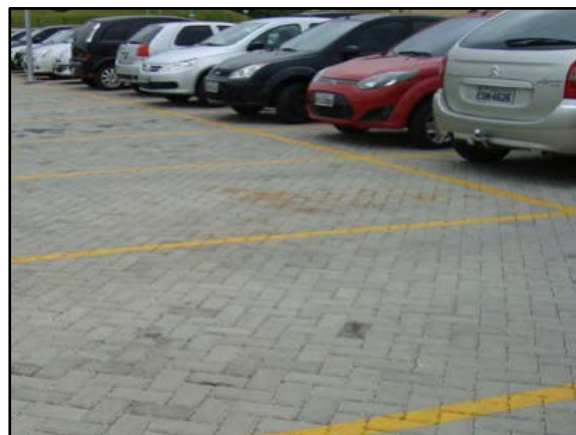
Pavimento poroso – piso intertravado instalado em passeio público
